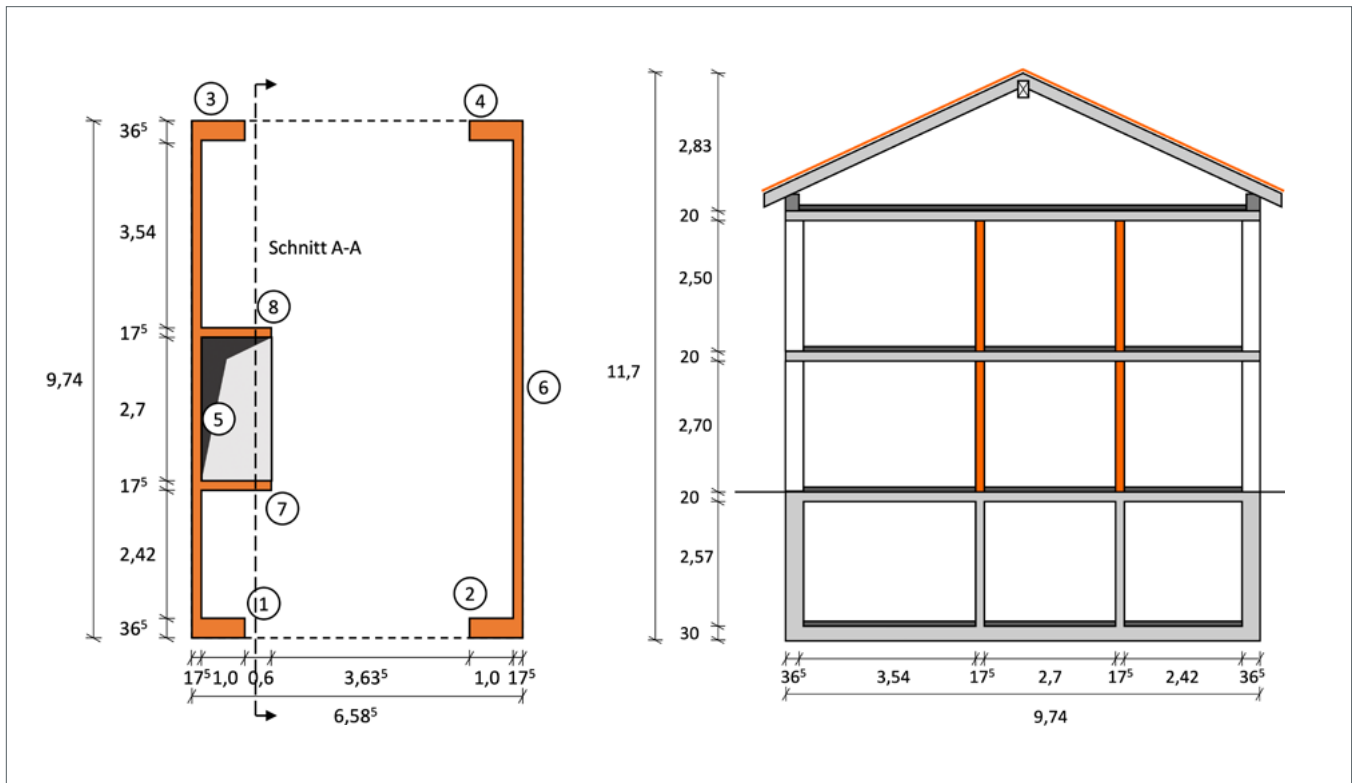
Grundriss und Schnitt A-A durch das Reihenhaus
